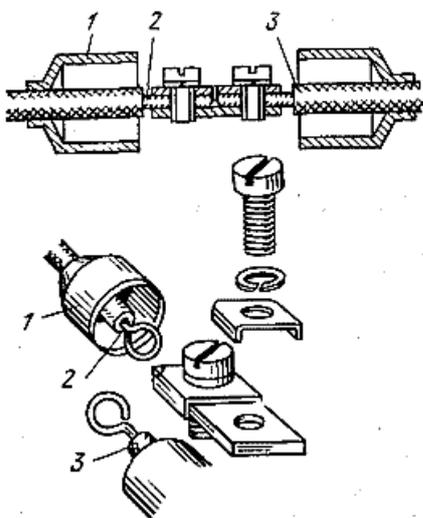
Соединение алюминиевых проводов сети с медными проводами осветительной арматуры:
